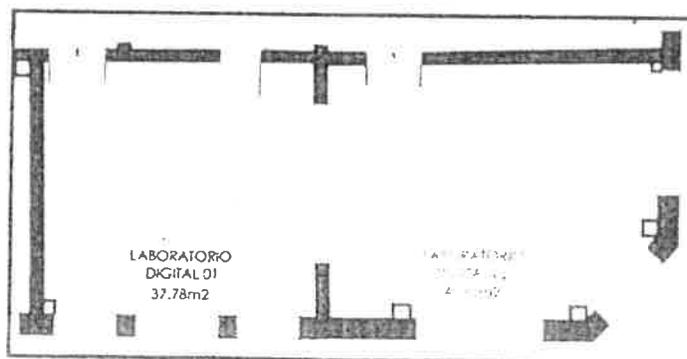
Planta de distribución de primer nivel, donde se muestra el ala este. Fuente: GCH/AMDC
